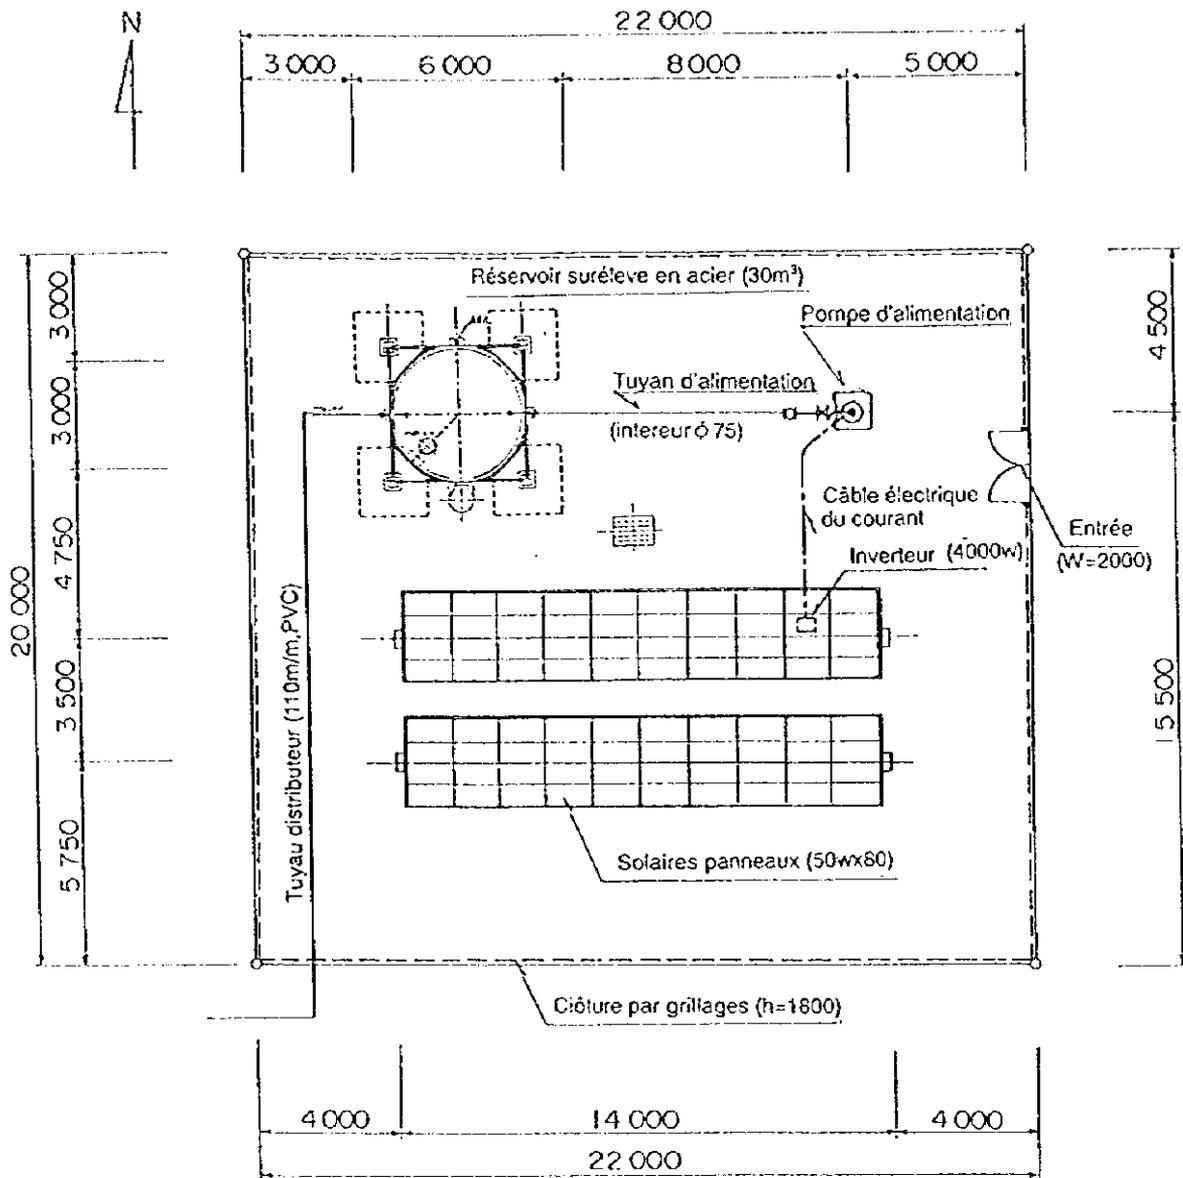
Plan de disposition d'une mini-adduction d'eau standard
